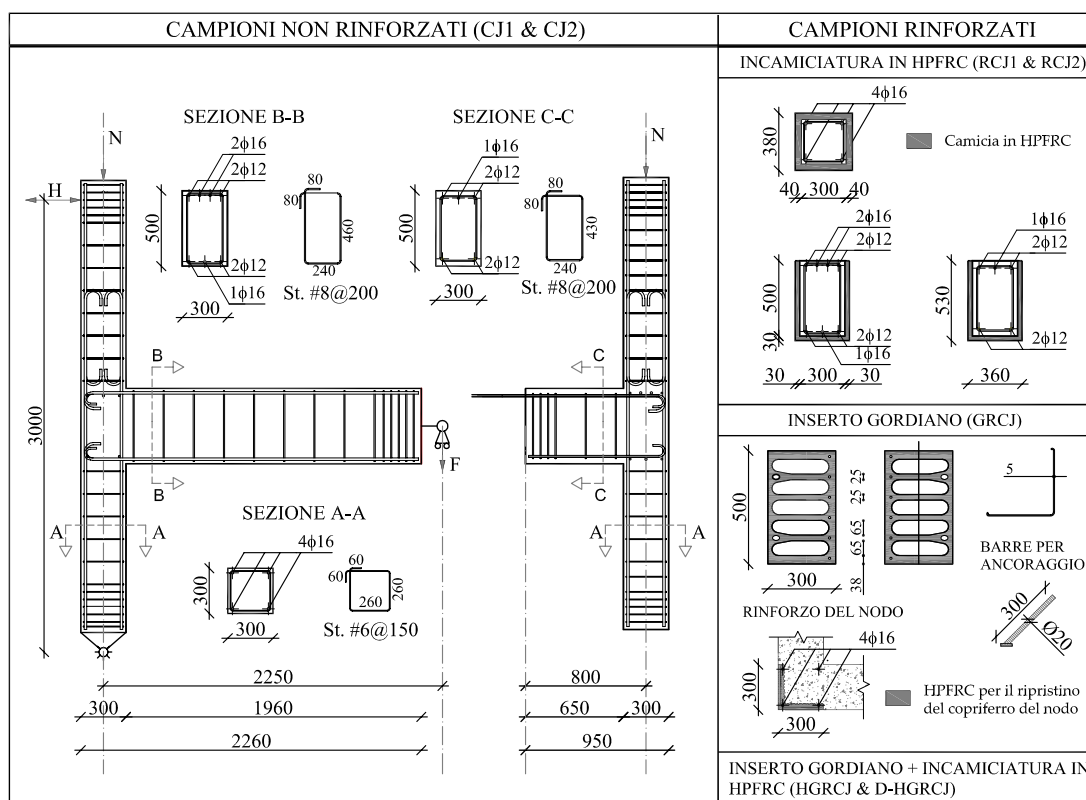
Geometria dei campioni di prova e dettagli delle armature
